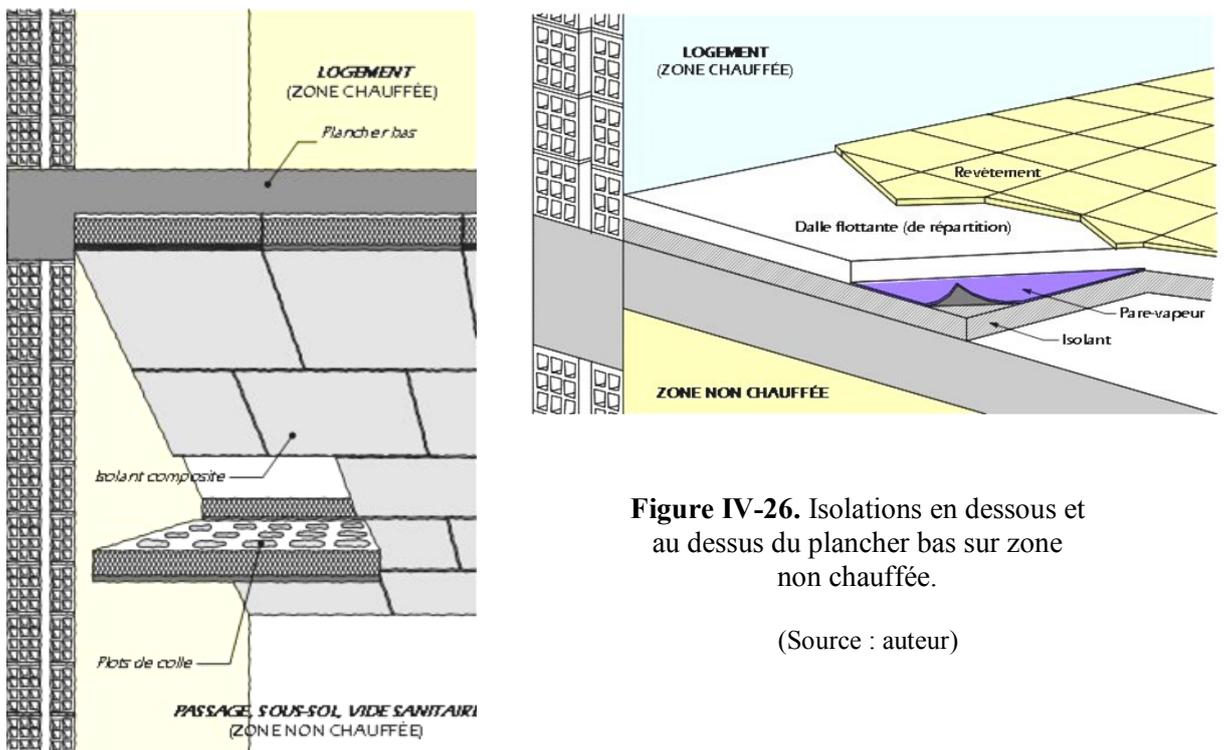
Isolations en dessous et au dessus du plancher bas sur zone non chauffée.
